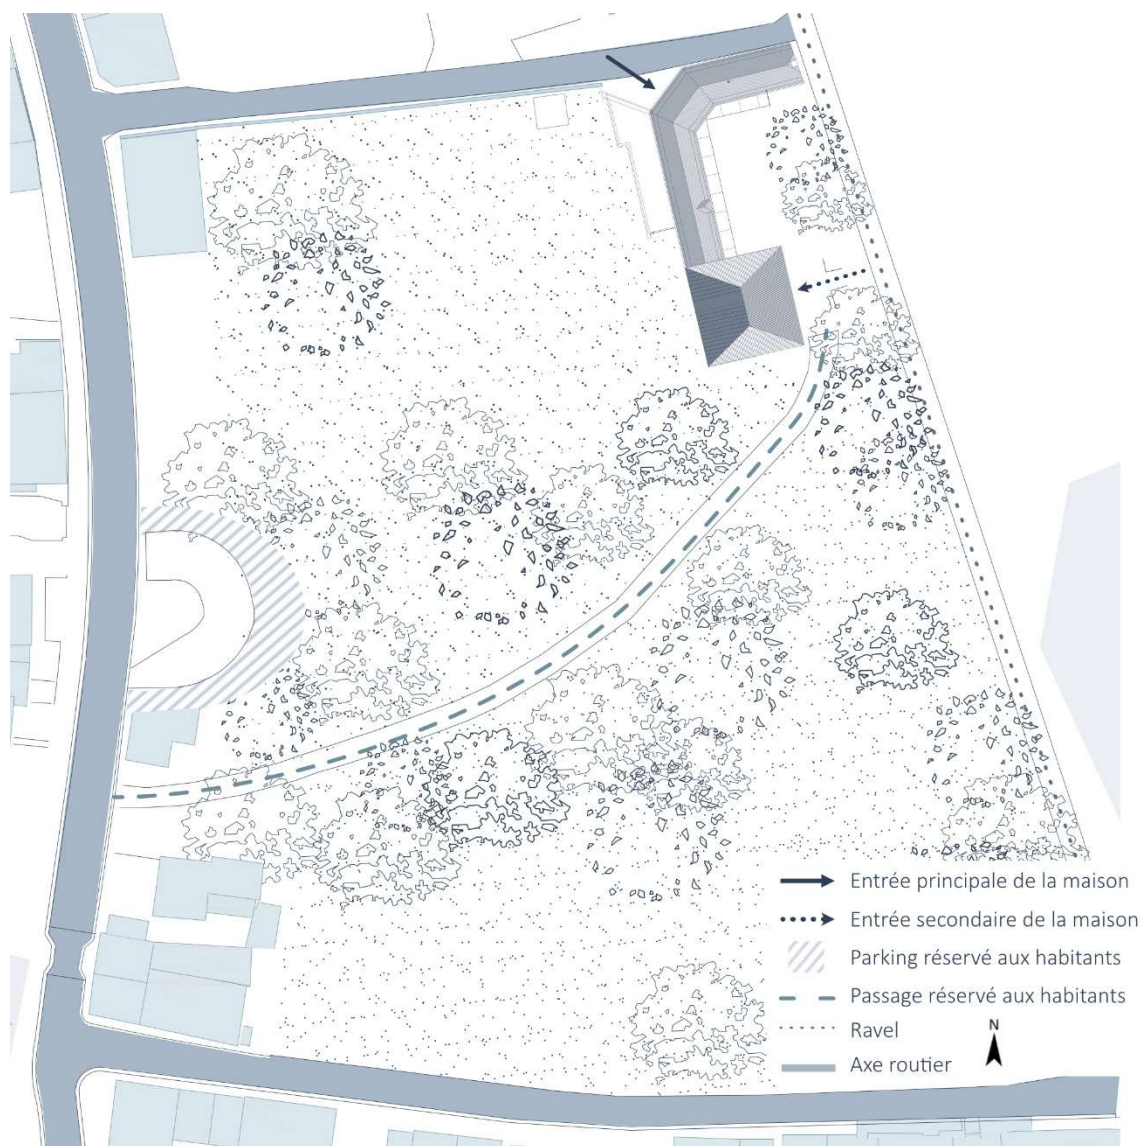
Implantation et accès- Maison Jean-Remacle de la Tour
